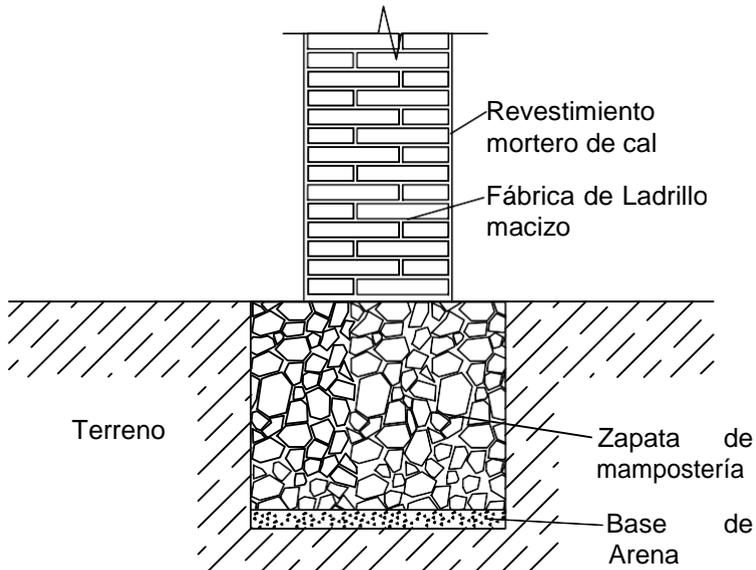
Detalle de cimentación. 2018. Fuente: Propia
